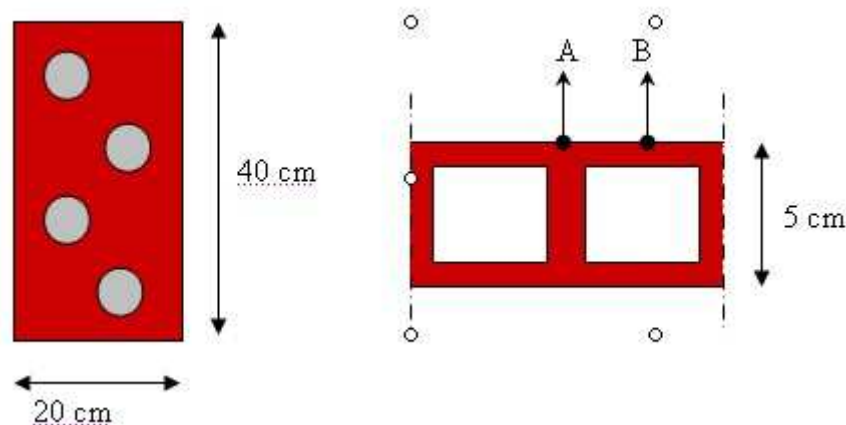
localisation des points d'arrachement, à gauche : 1/2 coupe transversale de la brique
